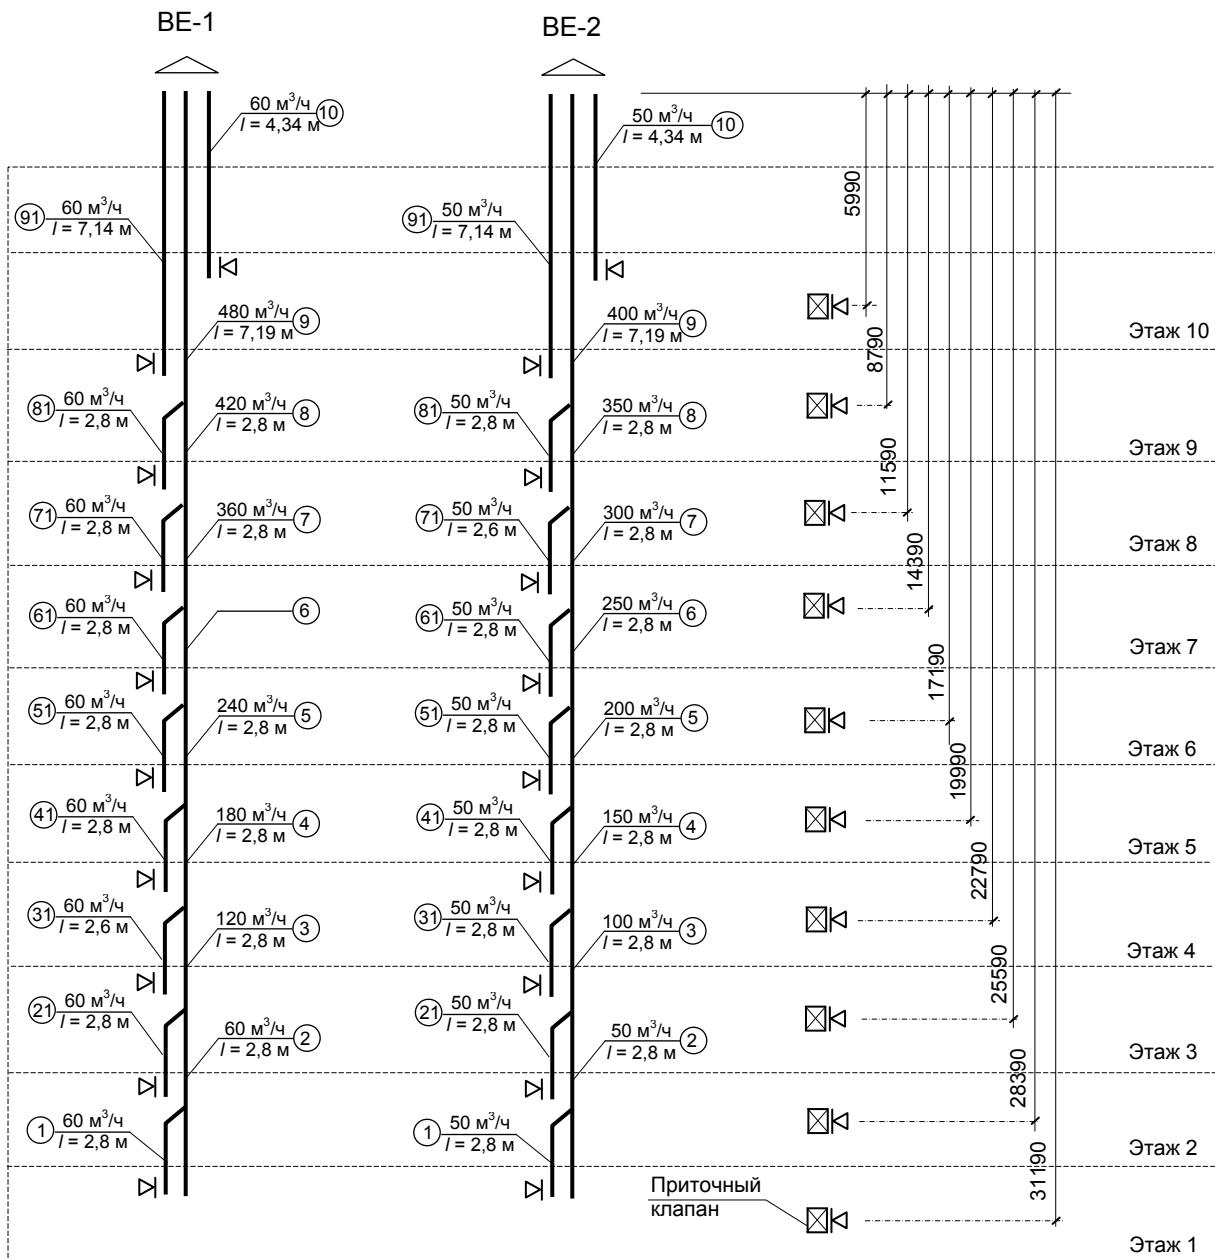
Расчетные схемы систем вентиляции BE-1 и BE-2
